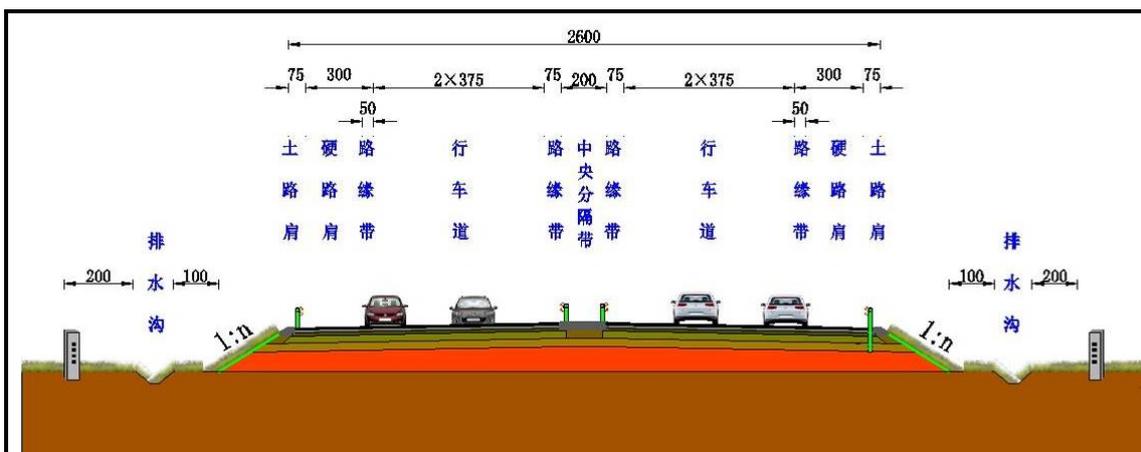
(1) 一般填方路基标准横断面图 (整体式 26m)
